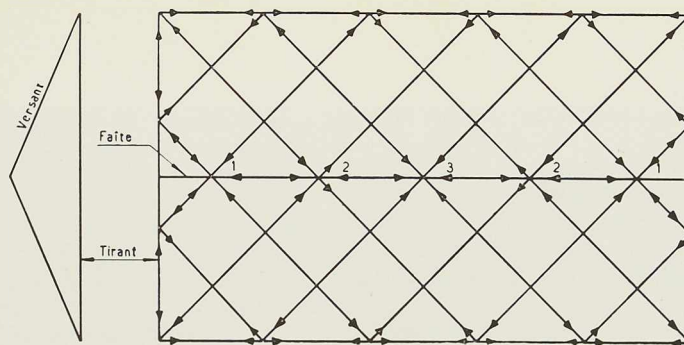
Plan et coupe d'une toiture en grillage avec panne faîtière.
